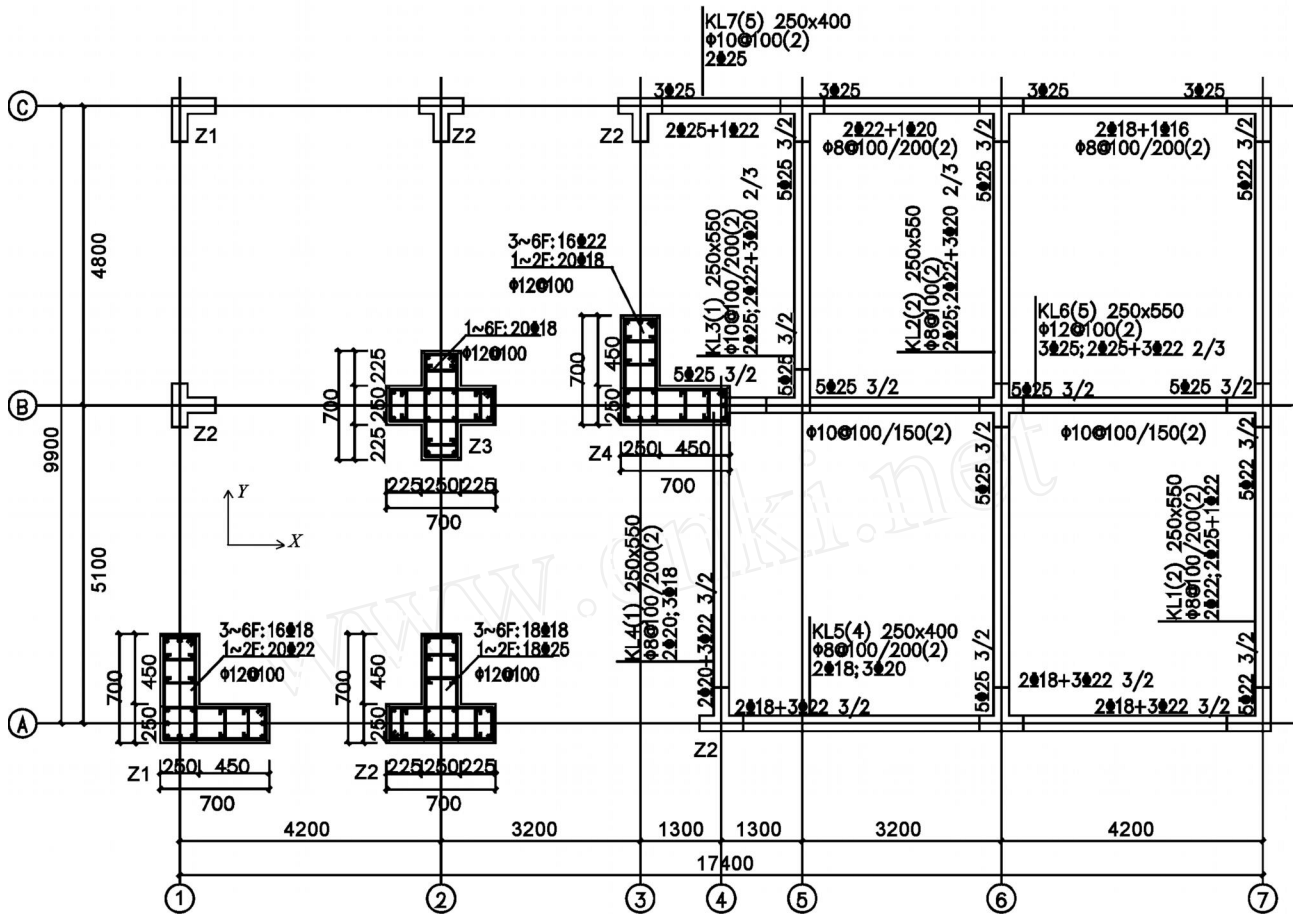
试验结构平面布置、柱配筋、1~3层梁配筋
